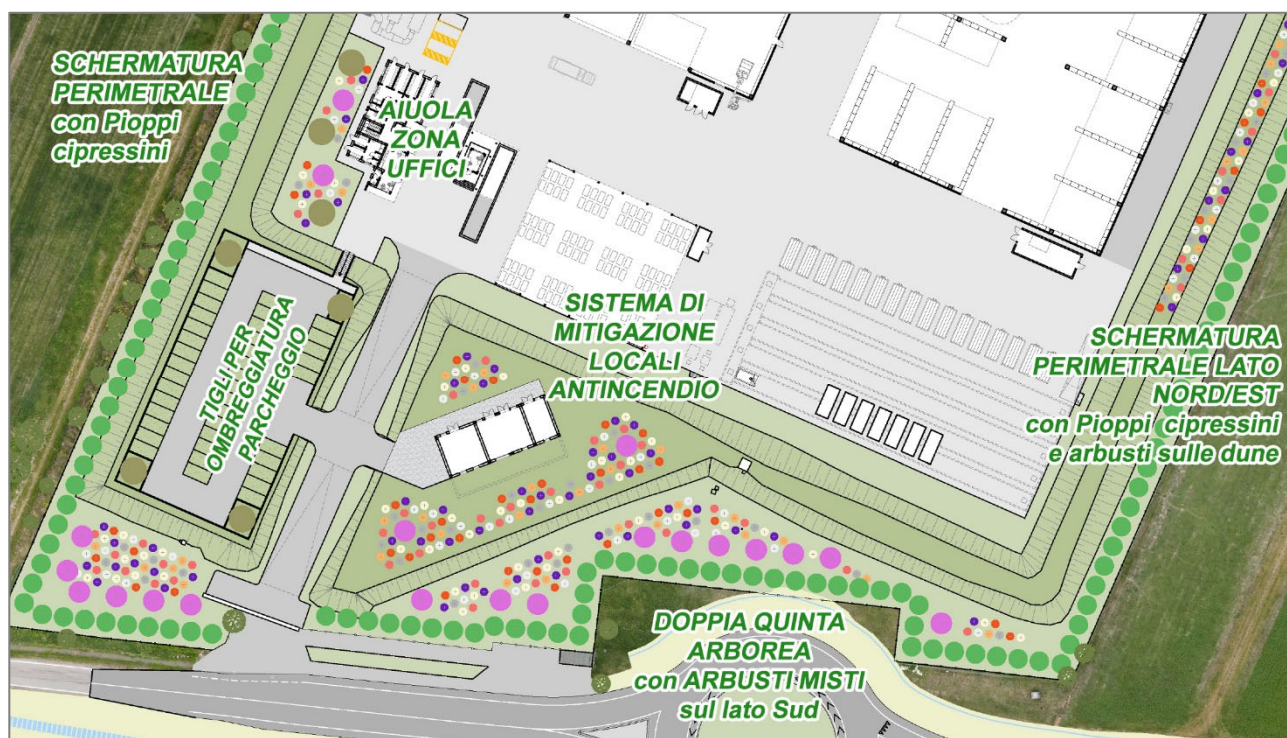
Estratto planimetrico con indicazione di massima delle opere a verde previste
